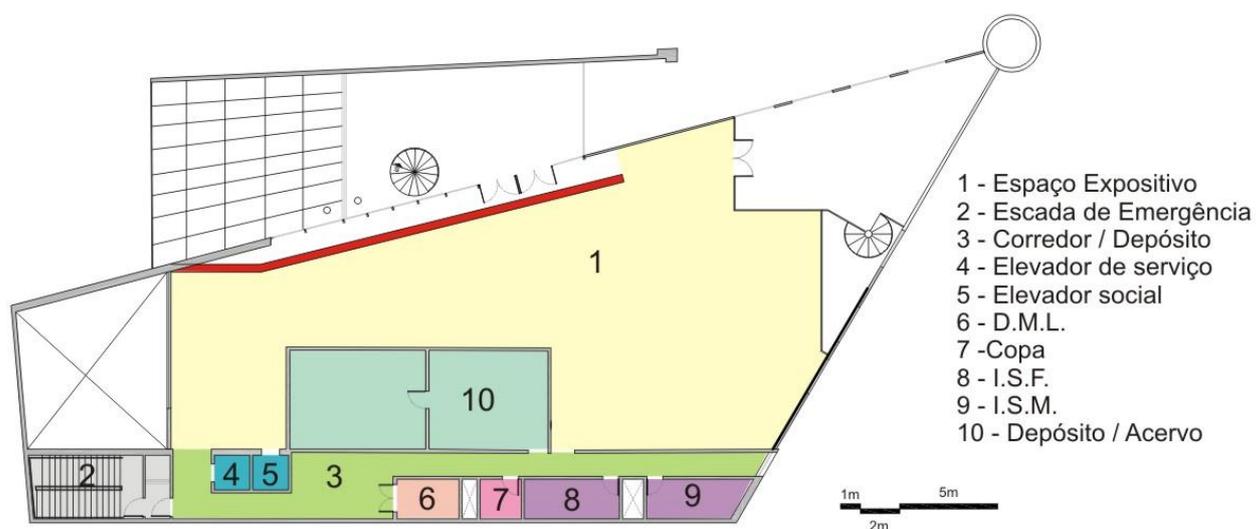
Planta Esquemática do Terceiro Pavimento (FONTE: FCC com intervenção do Autor)
